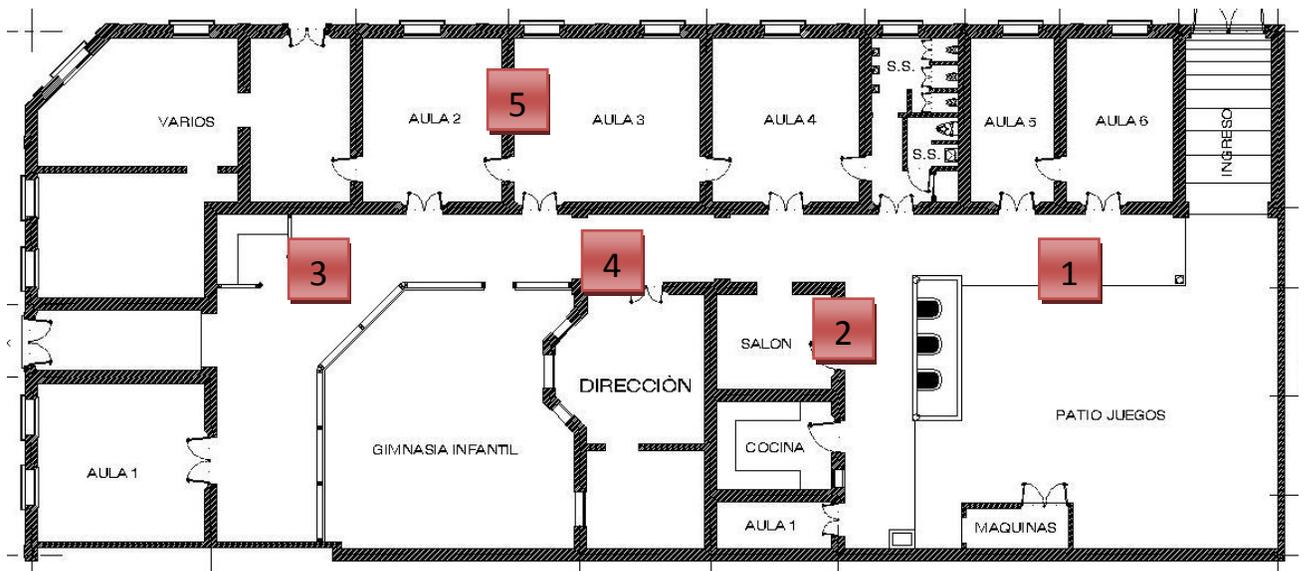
Ubicación en planta de las áreas con pisos a intervenir.
